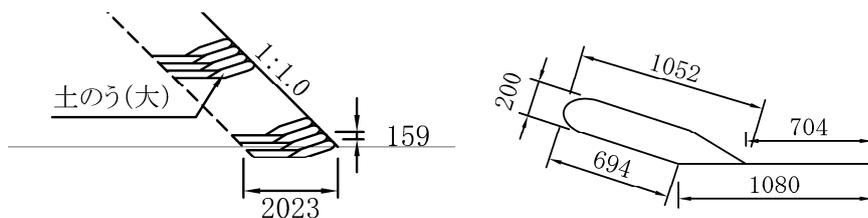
高機能土のう(大)の形状 (寸法例)
